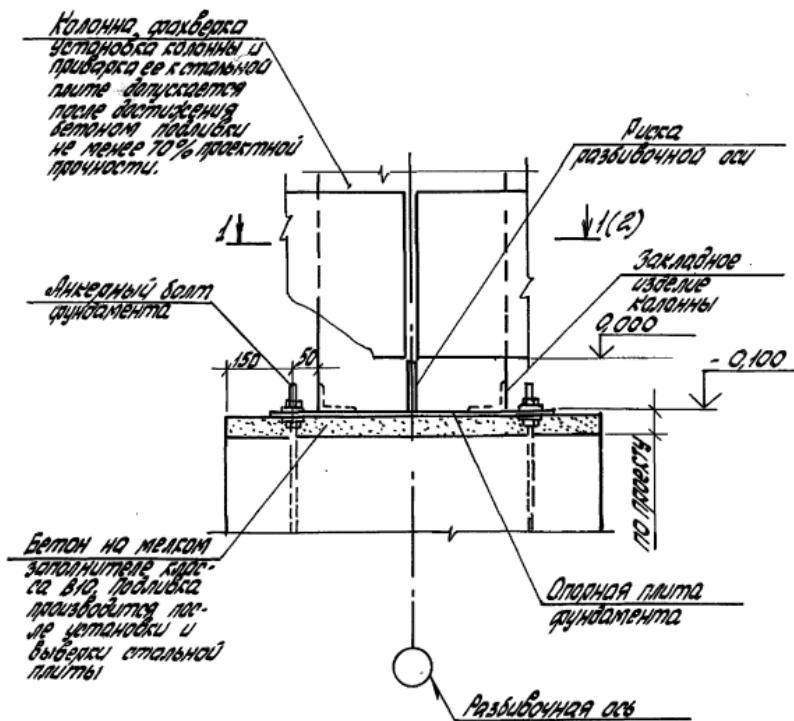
В поперечных перегородках у средних колонн здания с высотой сечения колонны ≤ 700 и у фронтальных колонн
